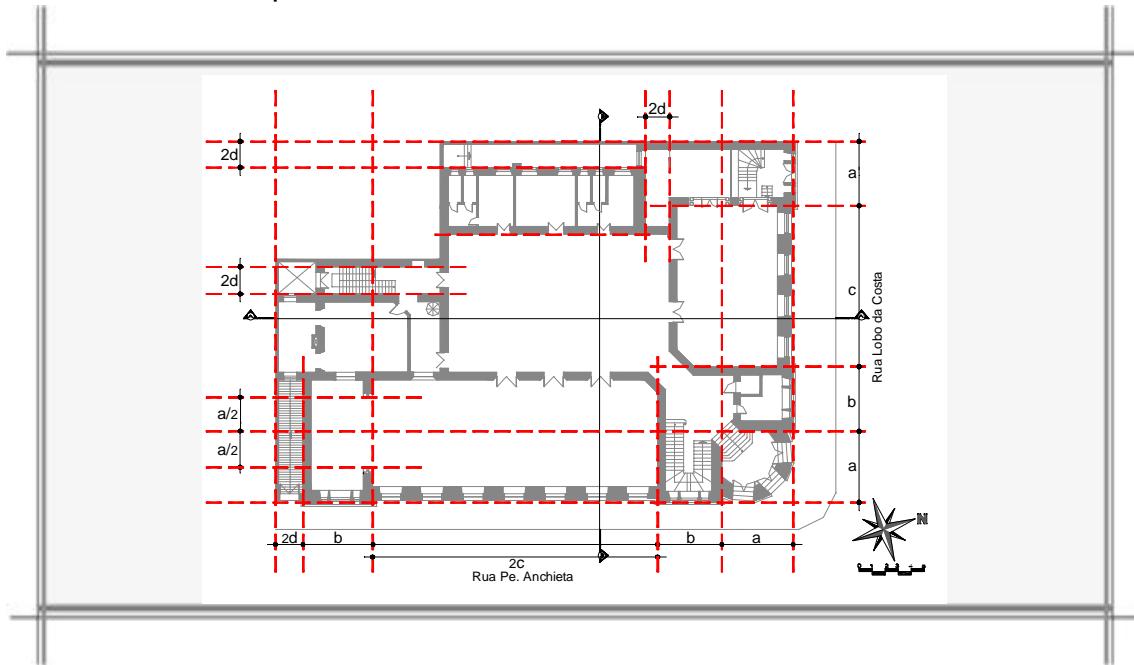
Análise de Taxe da Planta Baixa do 1º Pavimento. Desenho: Cristiane Müller.
